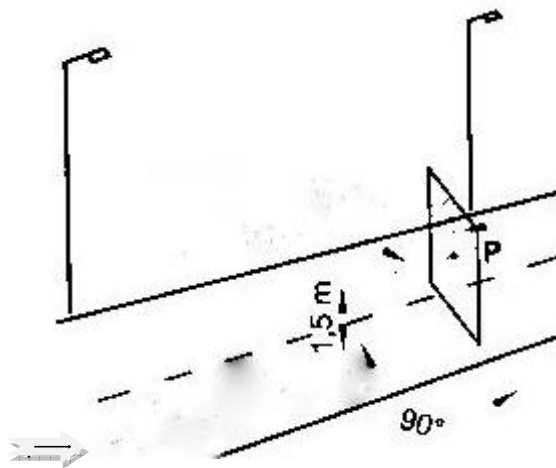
Posouzení osvětlení přechodu jasovou kamerou
